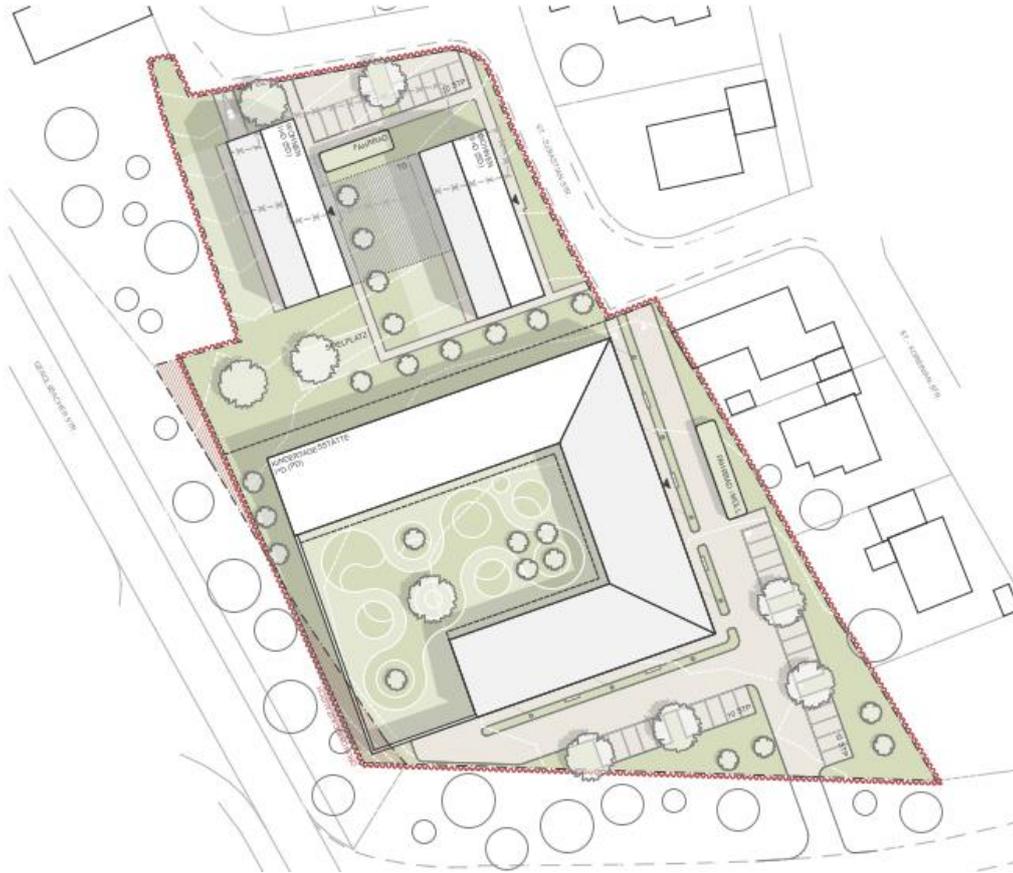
Lageplan Konzept, Stand 20.12.2022
